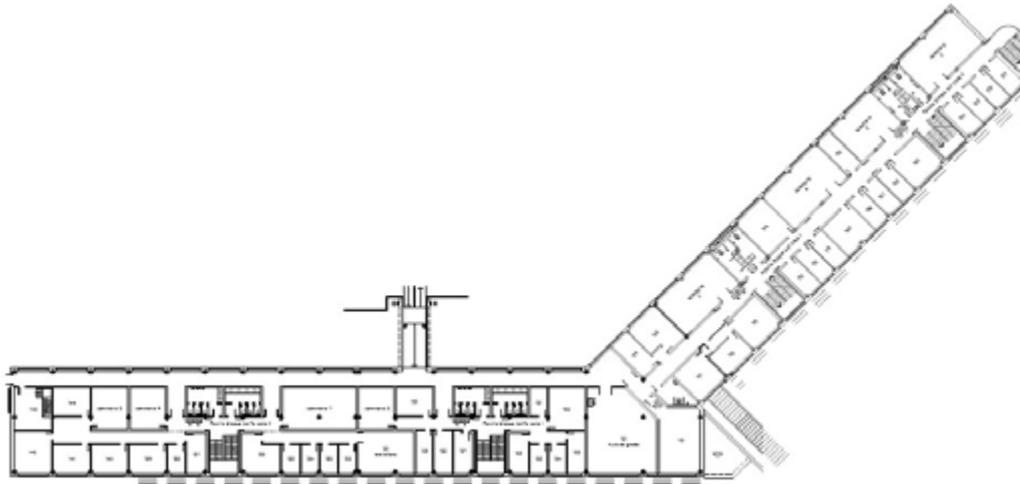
Vista en planta de los espacios en la sede campus de la EEI (Edificio II – Zona II)
